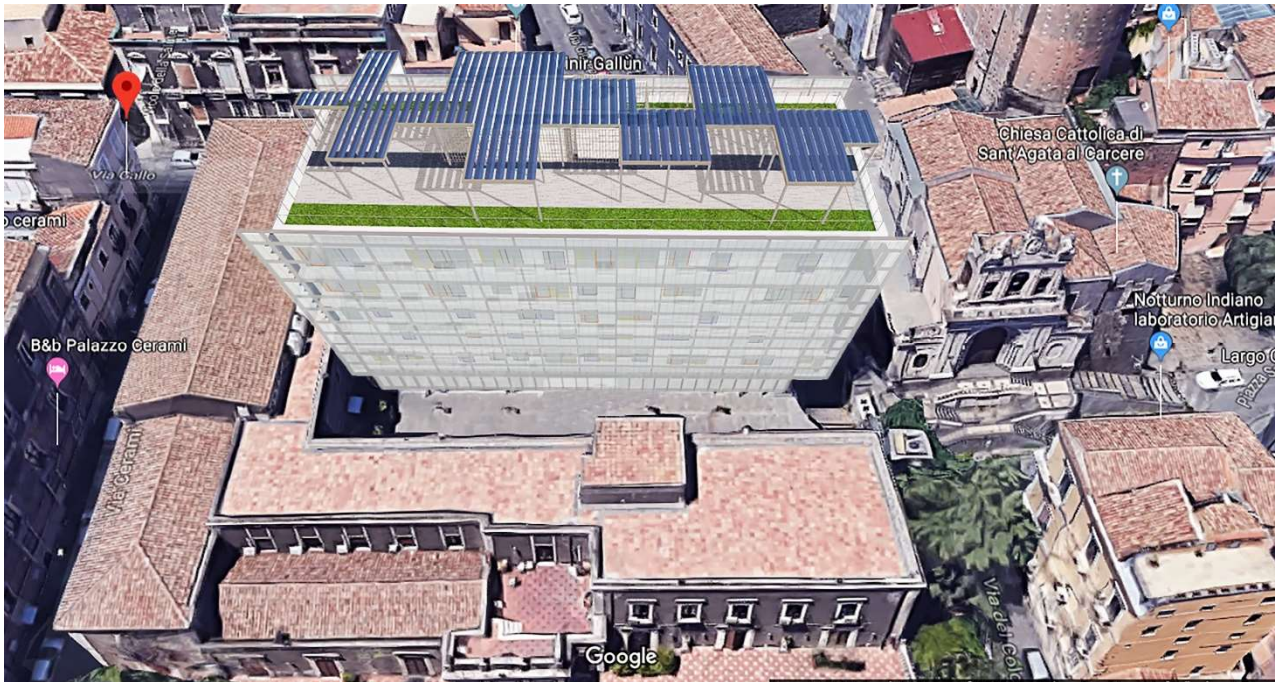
\_ Fotoinserimento vista da corte interna (prospetto est)
